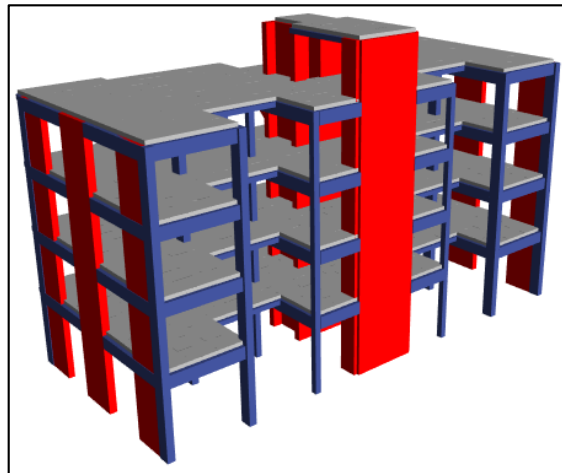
Vista conjunta posterior y lateral del modelo estructural 3D
